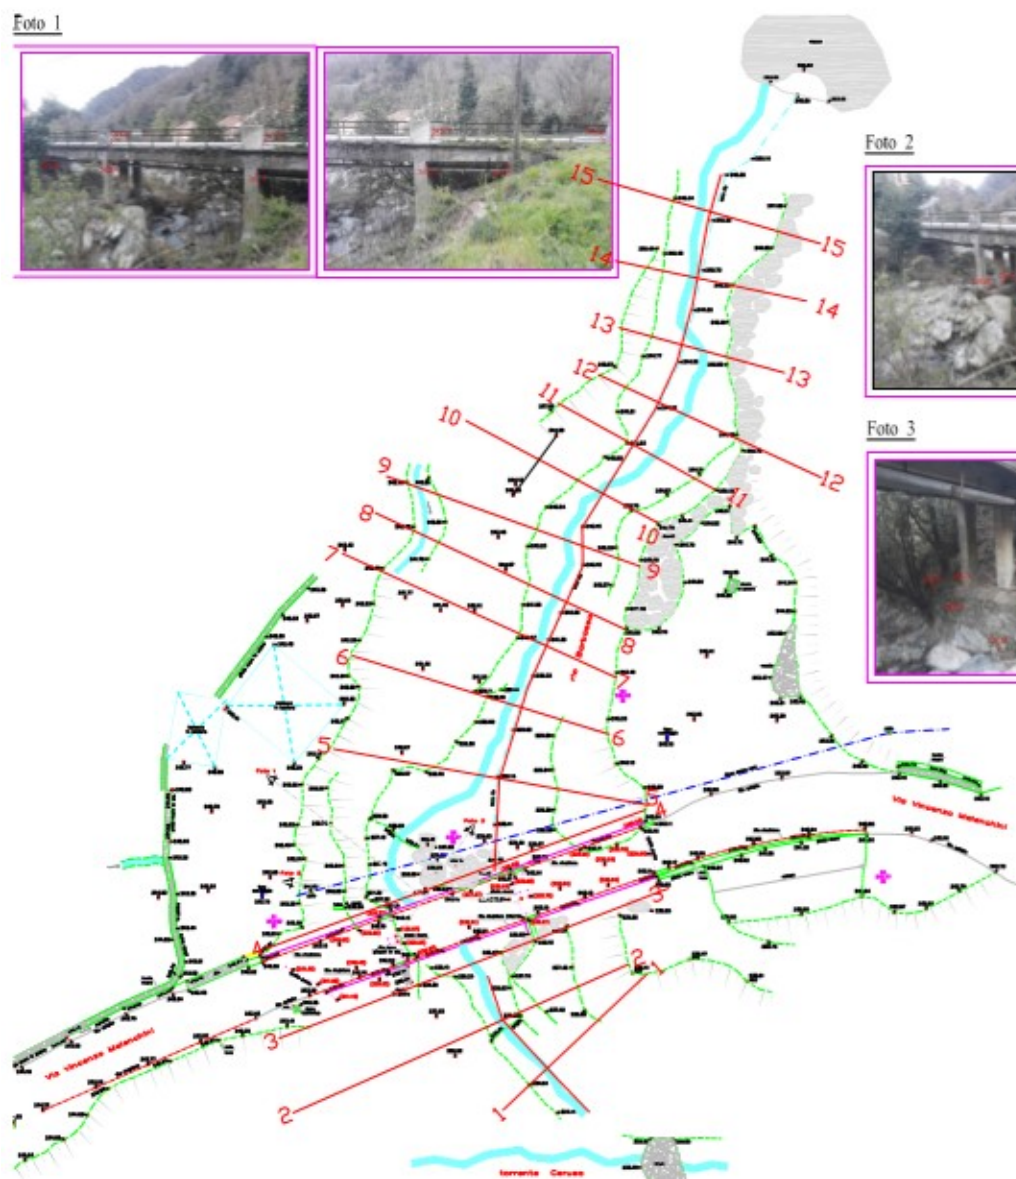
Planimetria stato attuale con riferimento delle sezioni
